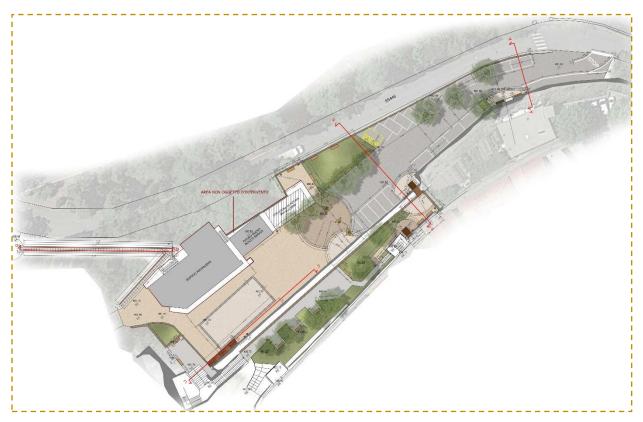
Planimetria generale del progetto sul lotto 1 e lotto 2. Estratto Tav.04.a_Planimetria generale_sdp.
